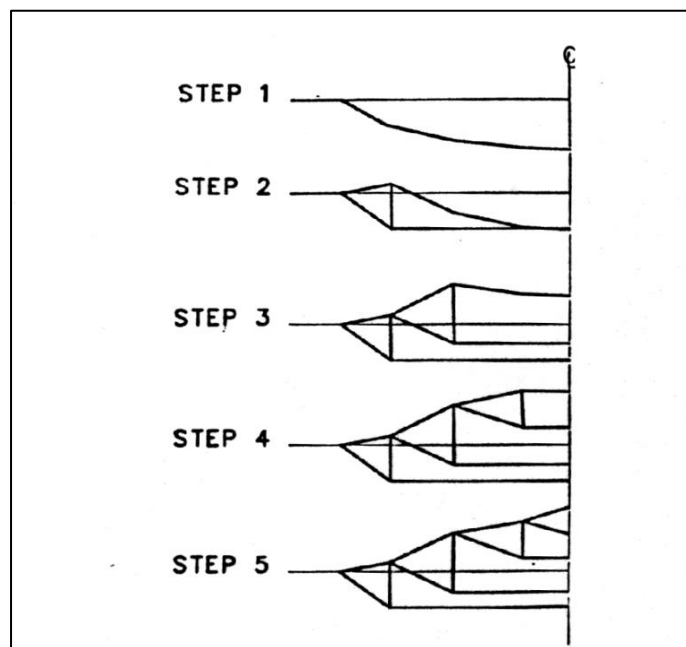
Secuencia de montaje de techo con estructuración tipo Tensegrity.
